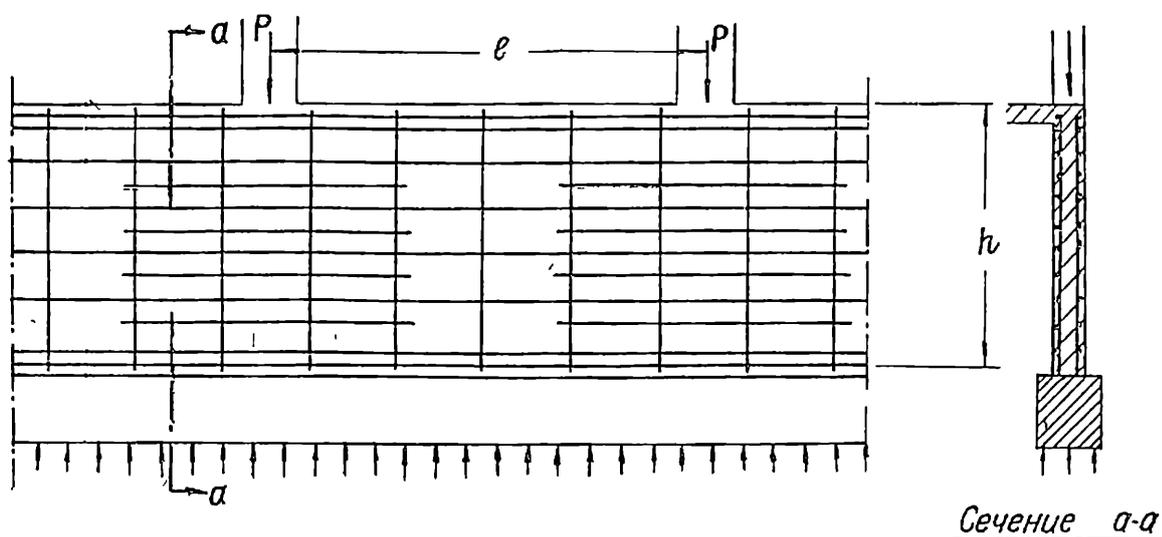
8. Армирование подвальных стен, которые загружены сосредоточенными нагрузками
